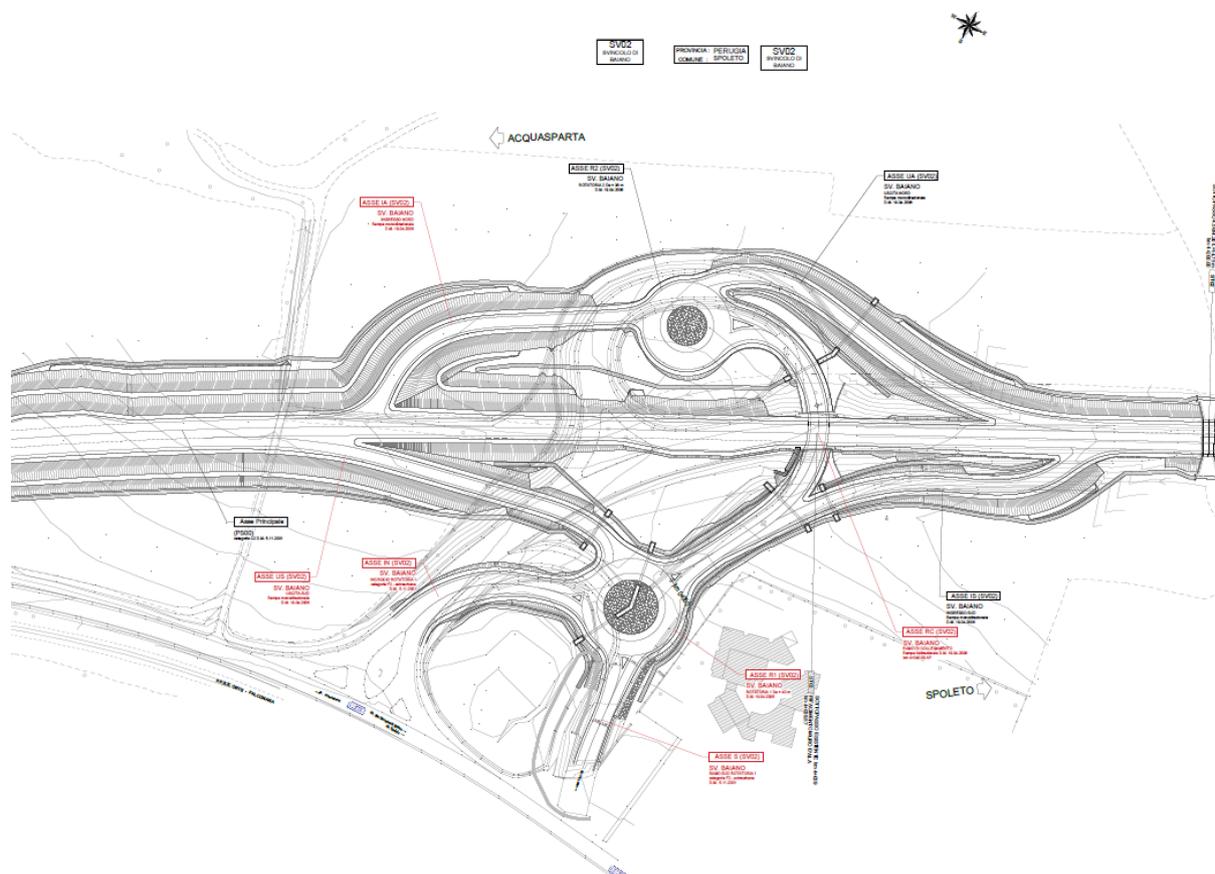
Svincolo di Baiano stralcio della planimetria di progetto
